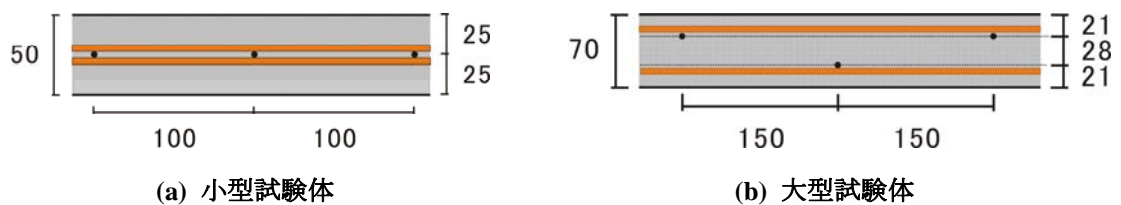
壁断面 (スラブ筋も同一の配筋) (単位 : mm)
